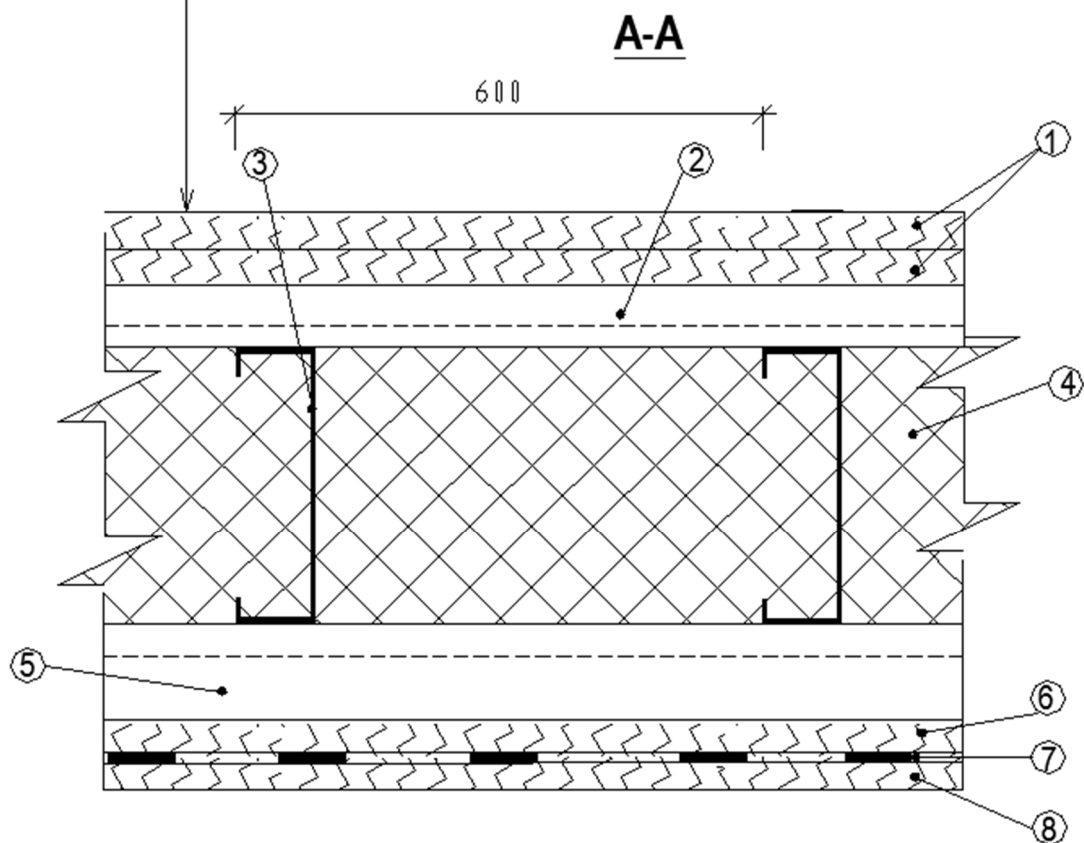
Схема конструктивного исполнения междуэтажного перекрытия
